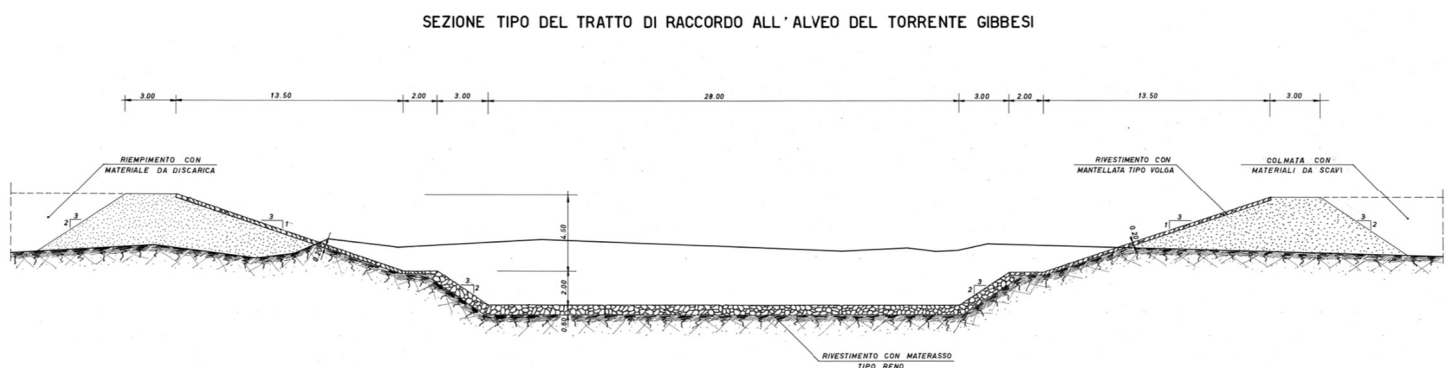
Progetto di fattibilità del 1972 – Sezione tipo del canale di restituzione
